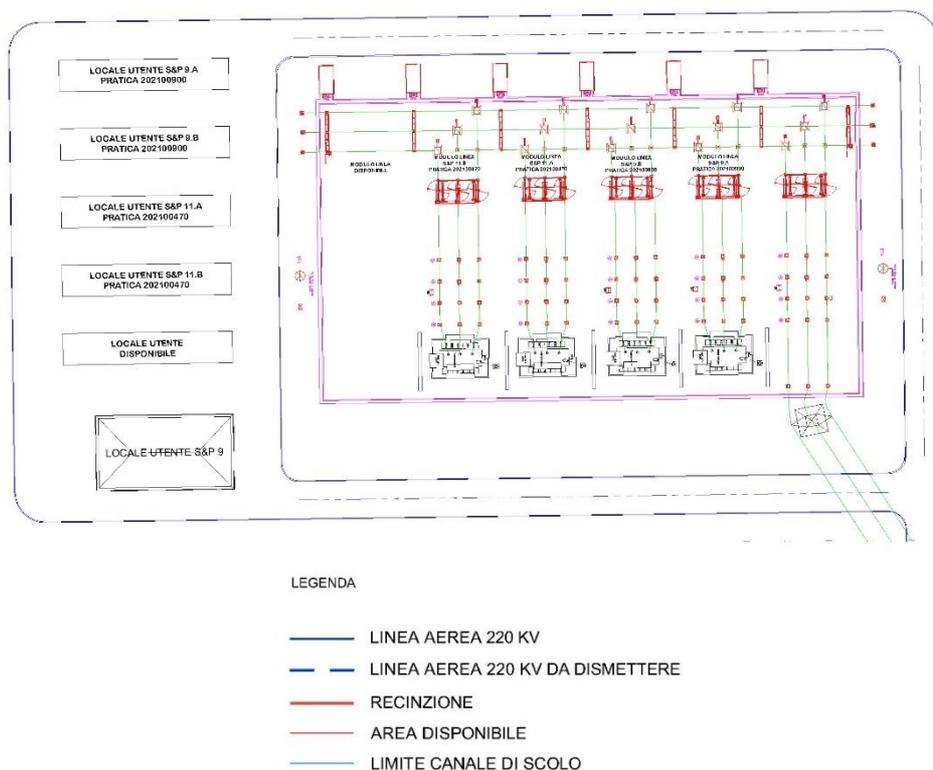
Pianta elettromeccanica generale – Stazione utente
